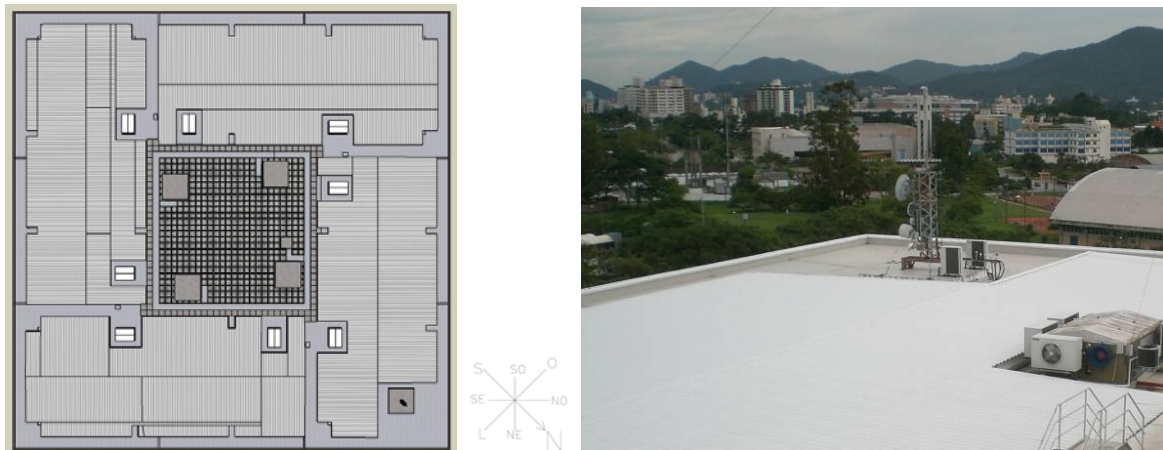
Cobertura do prédio e detalhe das telhas metálicas
